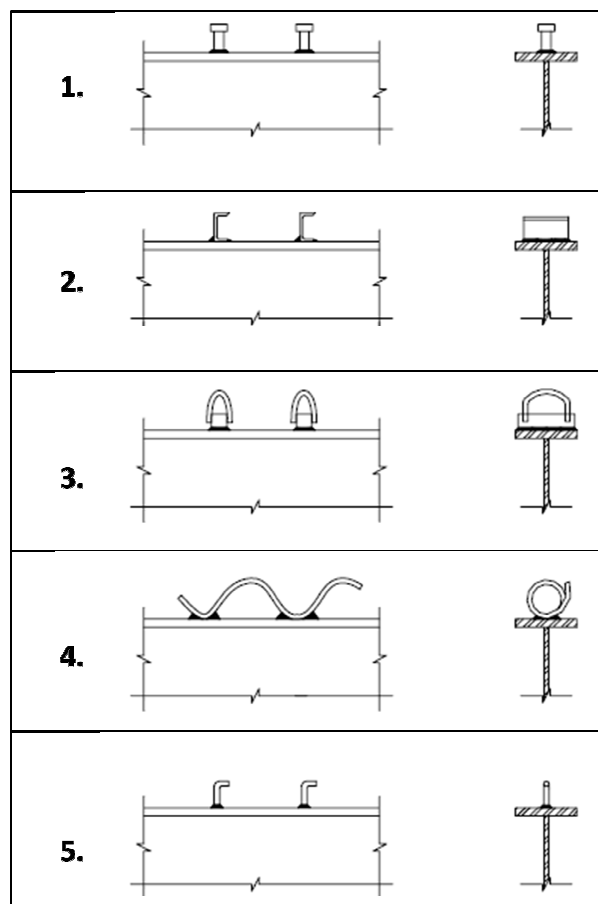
Conectores utilizados para ligação entre o aço e o betão [13]
